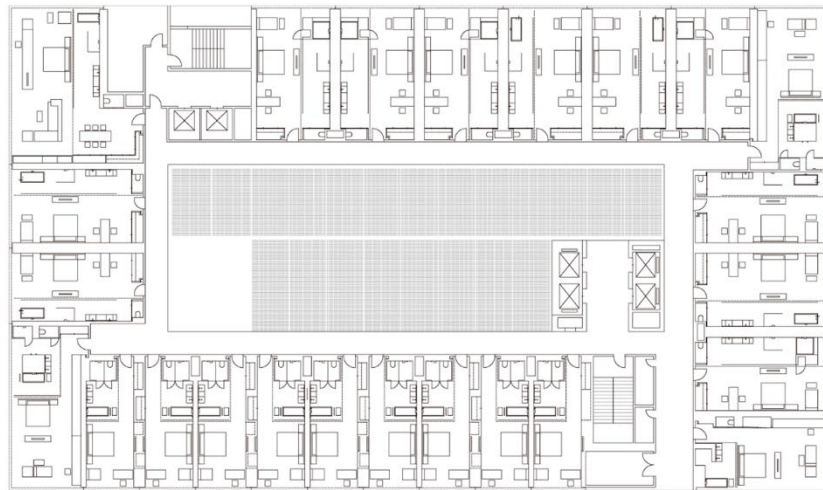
Plano de situación, edificio Hotel The Opposite House. Elaboración propia (2025)
